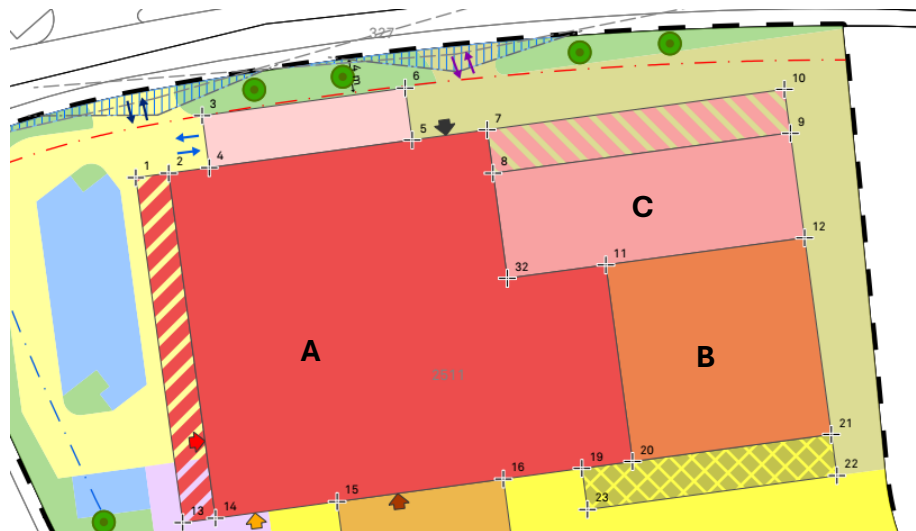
Baubereiche A, B und C im Gestaltungsplan.
